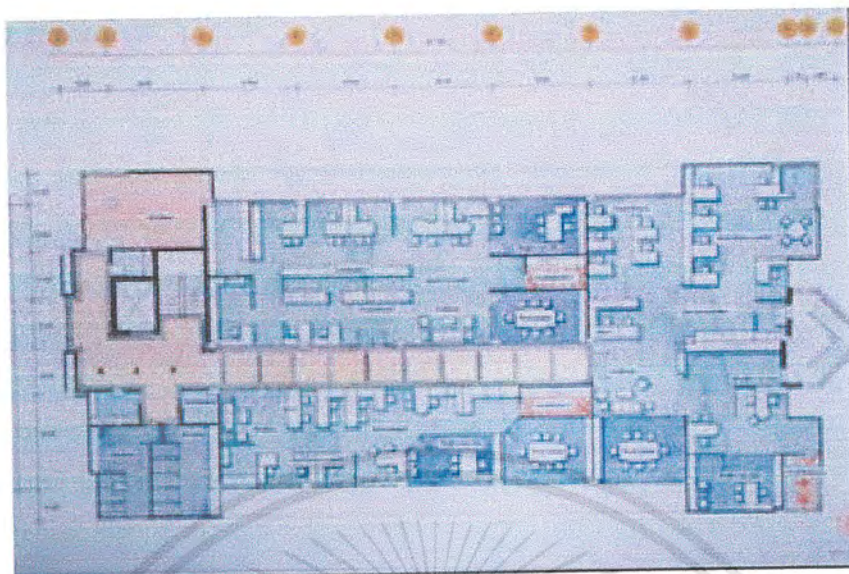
FURNITURE LAY-OUT PLAN 1 ST
